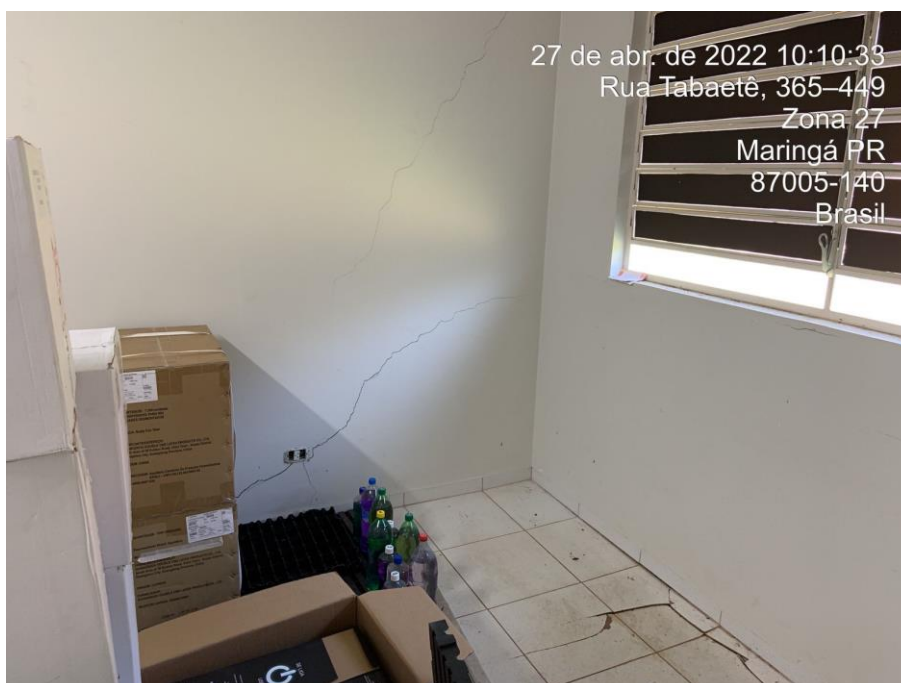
Vista parcial da sala 53, destacando trincas de conformações diagonal e horizontal em alvenaria.
